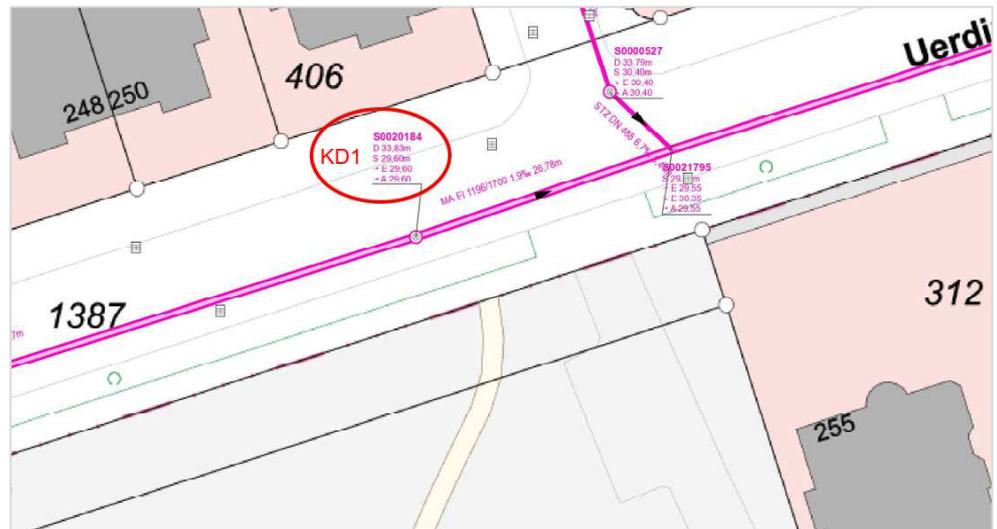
Ausschnitt Lageplan [U 3] mit Bezugshöhenpunkt KD1
